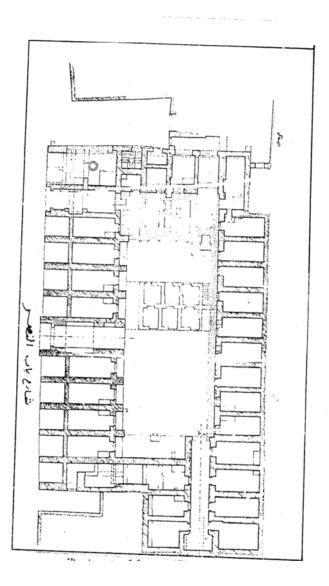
مسقط أفقي لمدرسة قايتباي بالصحراء شمال شرق القاهرة
